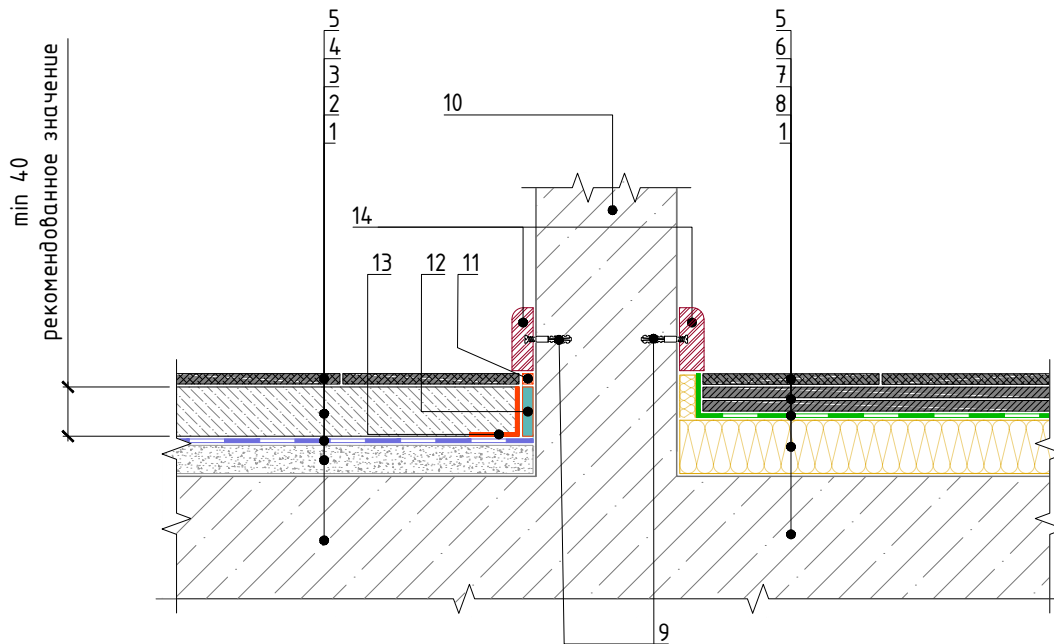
Схема конструктивного решения узла примыкания пола на звукоизоляционном слое к стене (перегородке)
